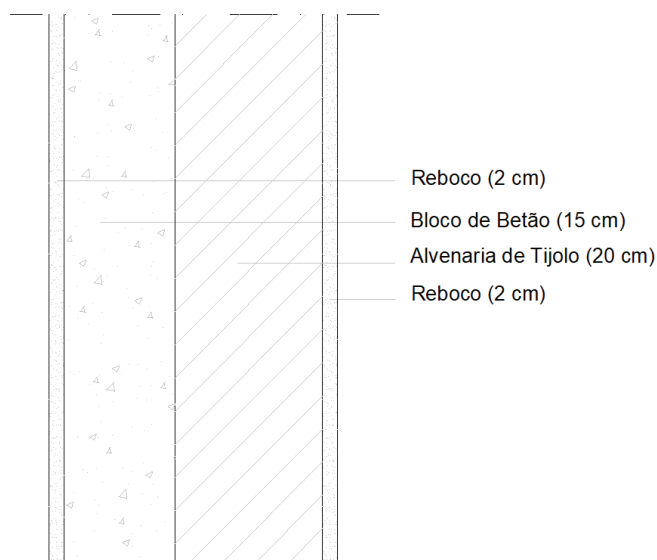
Pormenor construtivo da parede interior tipo XVII (circulação)
